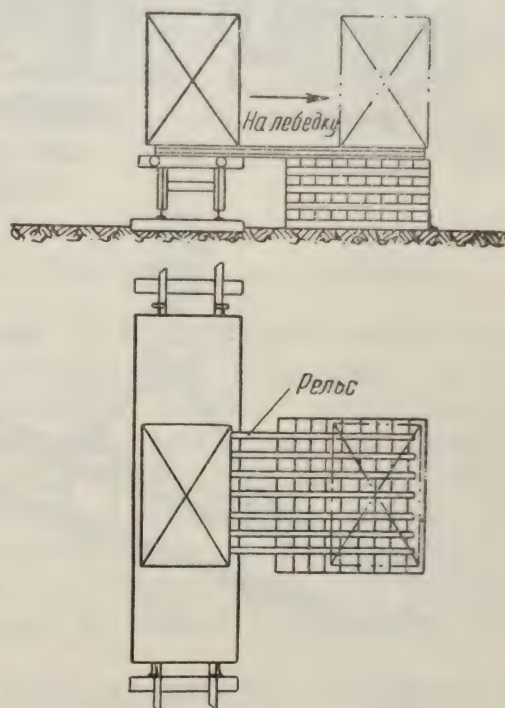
Разгрузка тяжеловесного оборудования с железнодорожной платформы на шпальную выкладку.
